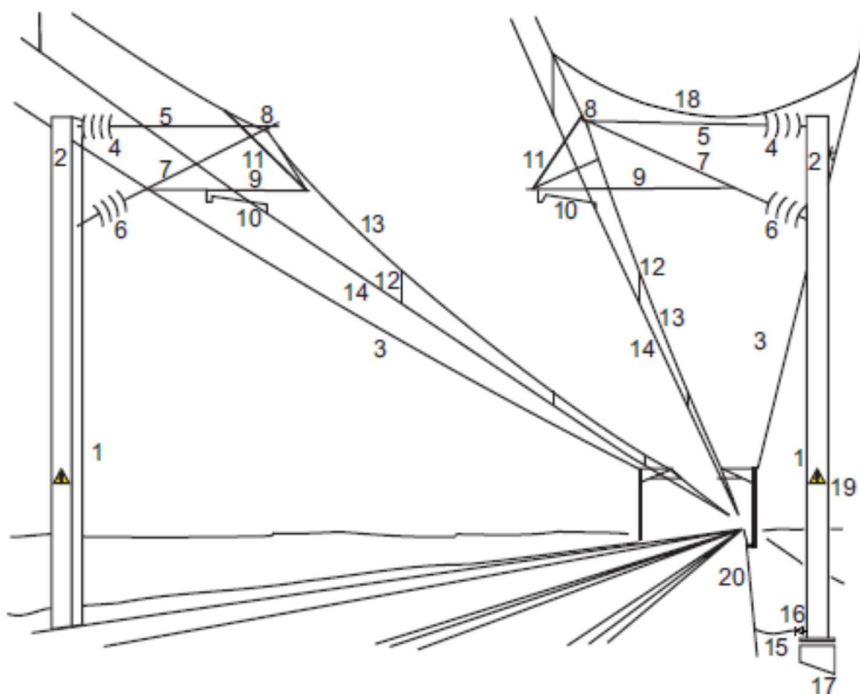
Eksempler på kørestrømsanlæggets komponenter (Fjernbane)
